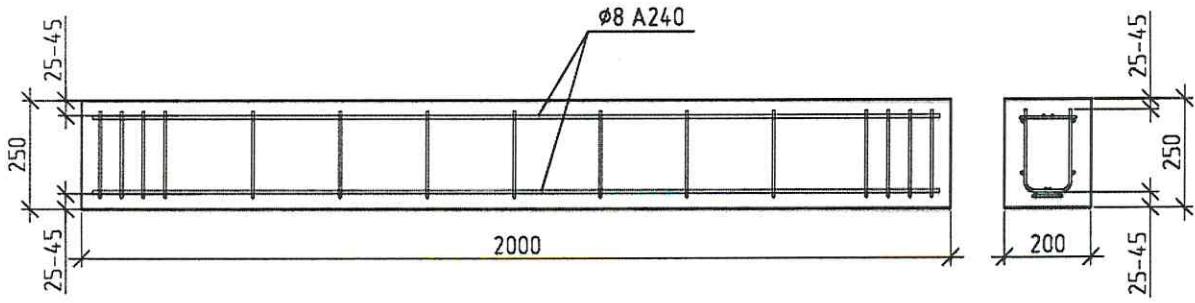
Схема армирования перемычки с плоским каркасом
